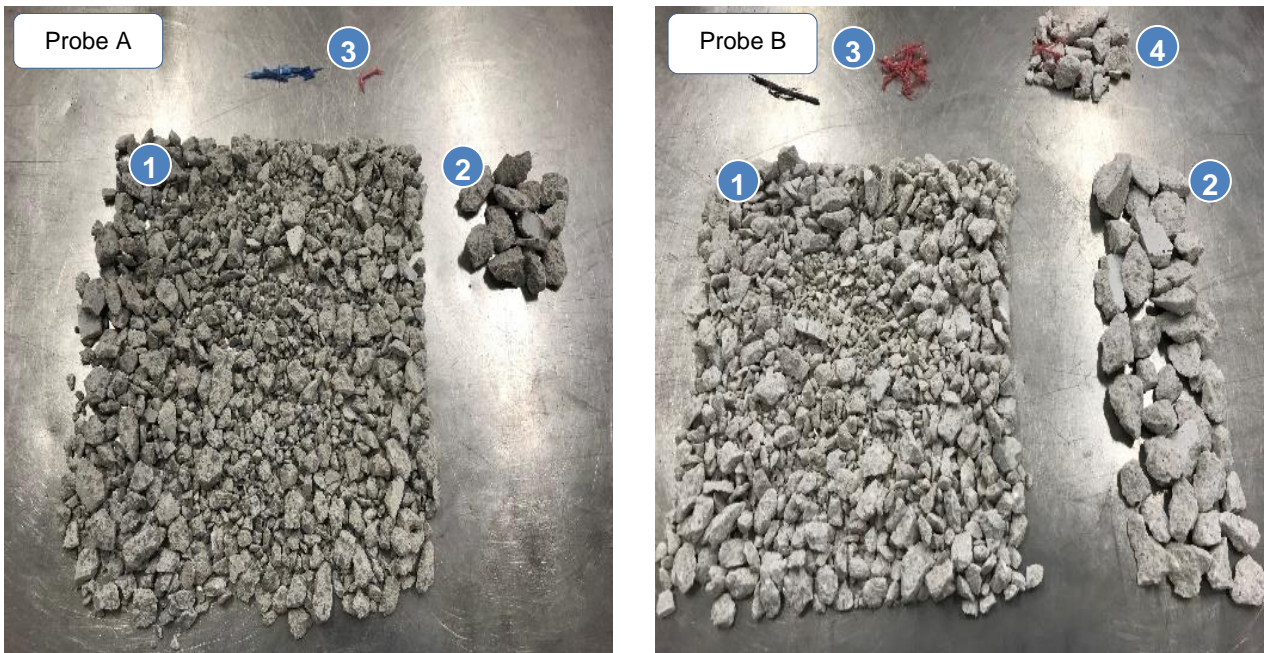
Bestandteile der untersuchten RC-GK_c. 1. Betonbruch 2/16; 2. Betonbruch 16/32; 3. Faserreste; 4. Betonbruch mit eingeschlossenen Faserresten.
